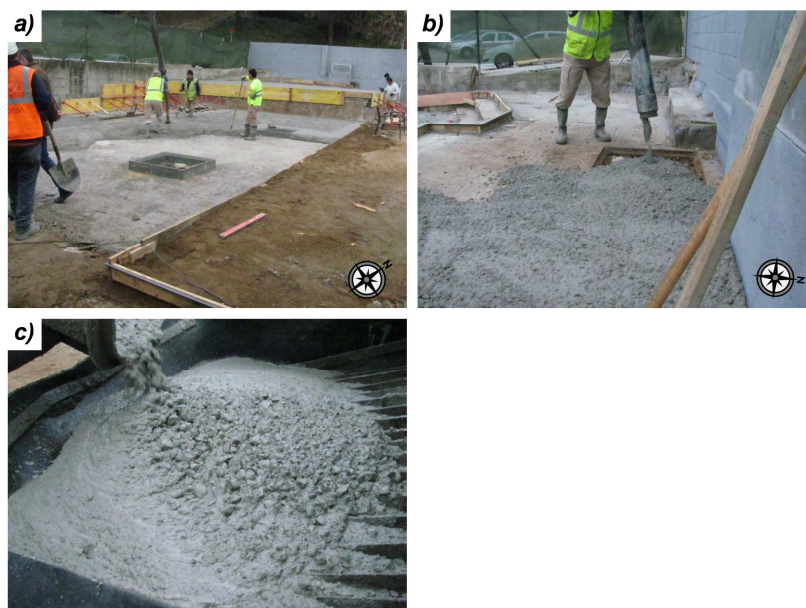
64 – a) vertido mediante bomba en losa norte; b) vertido en losa norte superior; c) hormigón
